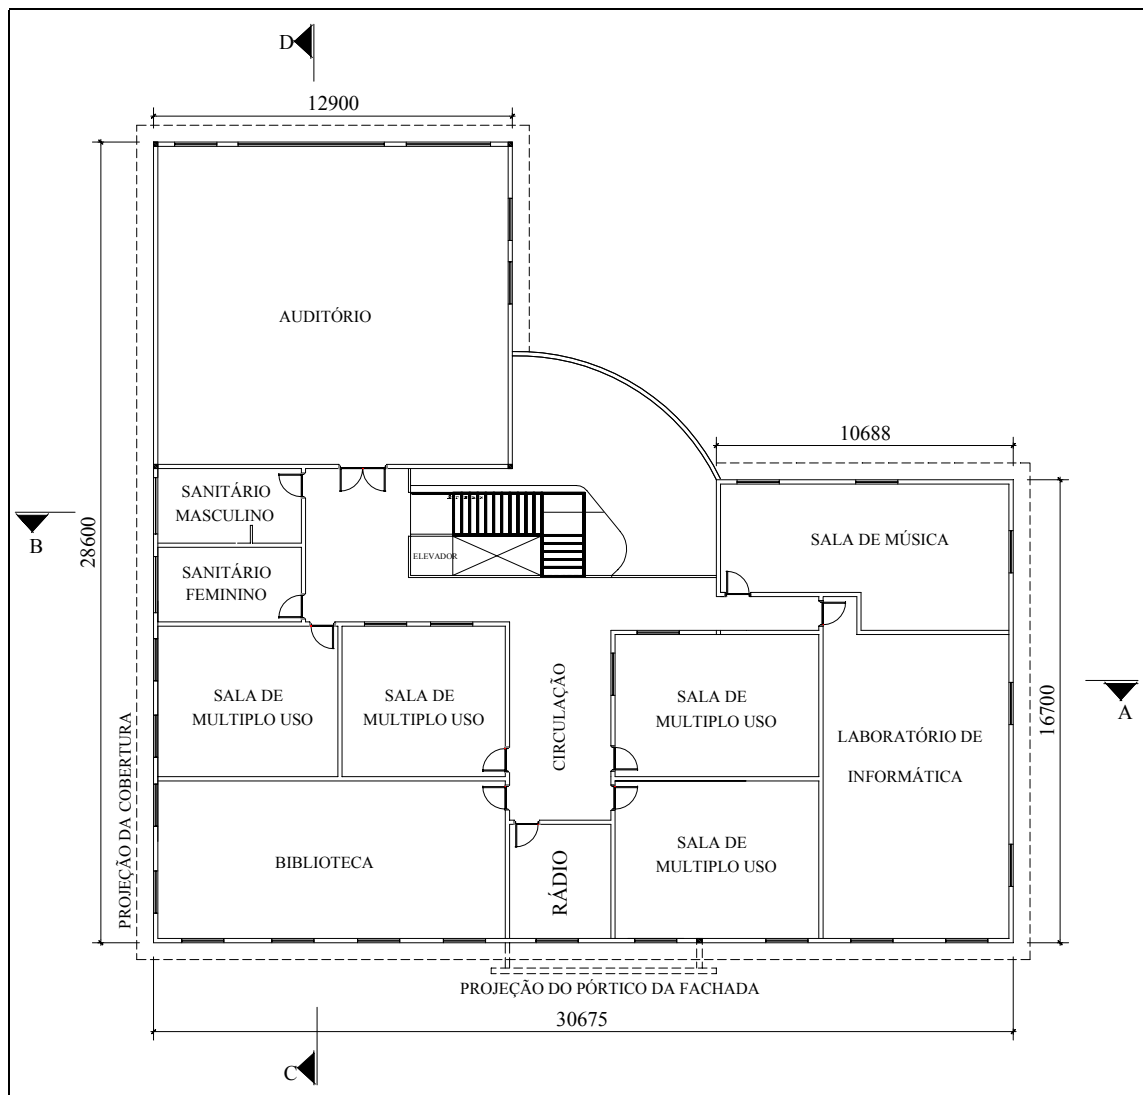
Planta do segundo pavimento do Edifício 3.
